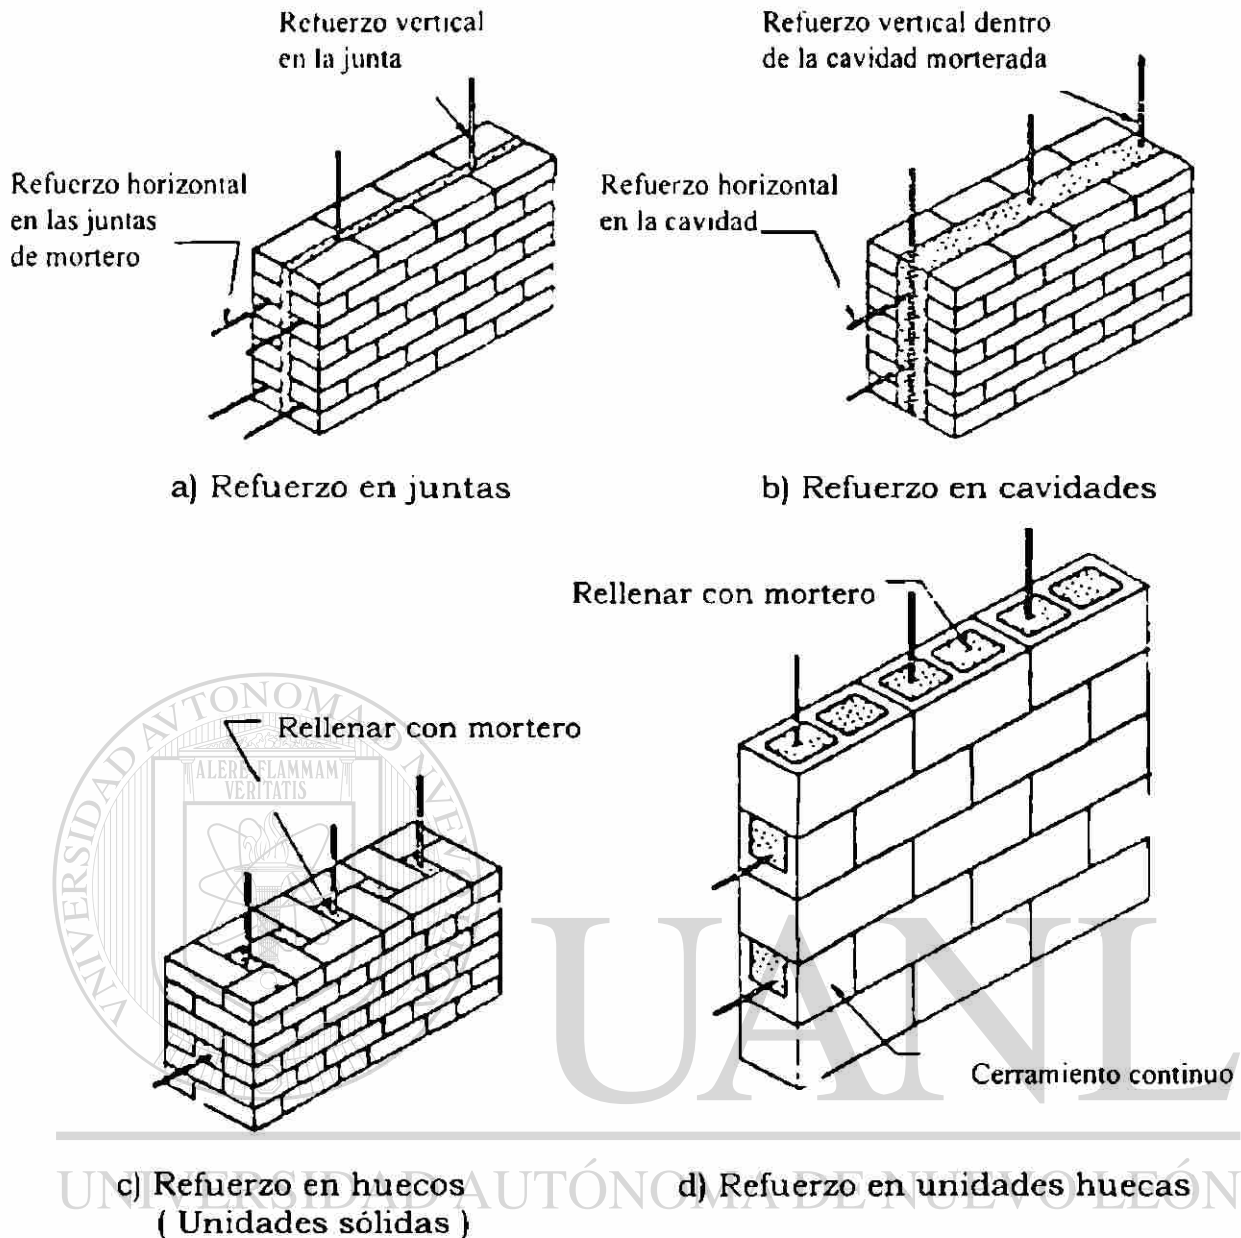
Localización del refuerzo en muros de mampostería.
